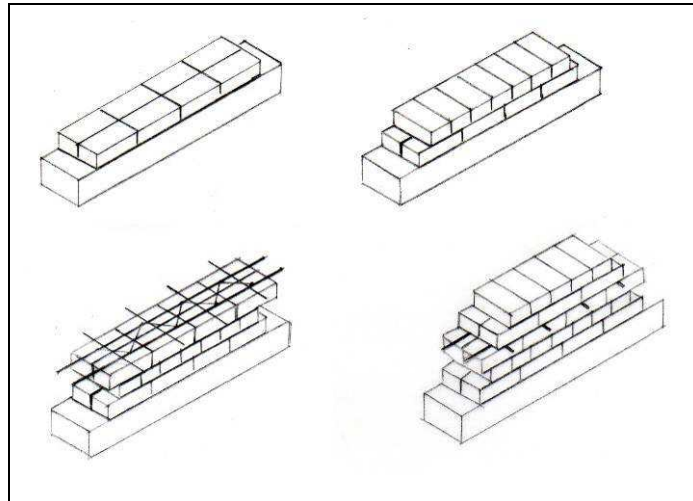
Aparejamiento de bloques y realización de refuerzo horizontal
